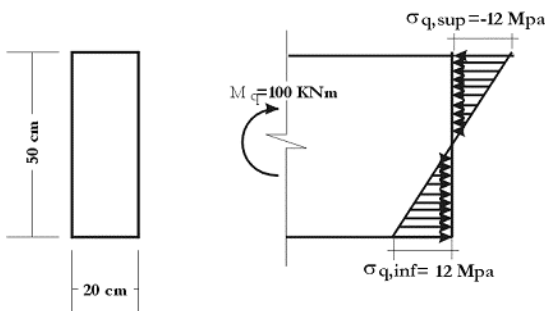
Diagrama de Tensões Normais – Viga de Concreto Armado
